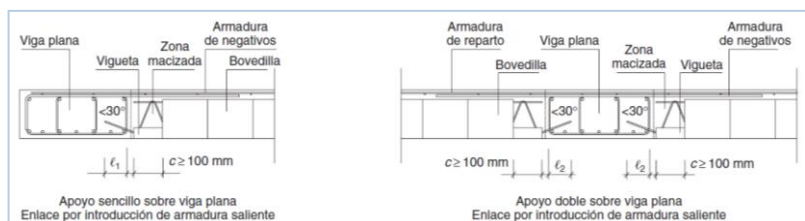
y 26. Apoyo sobre viga plana. Enlace por introducción de la armadura saliente
